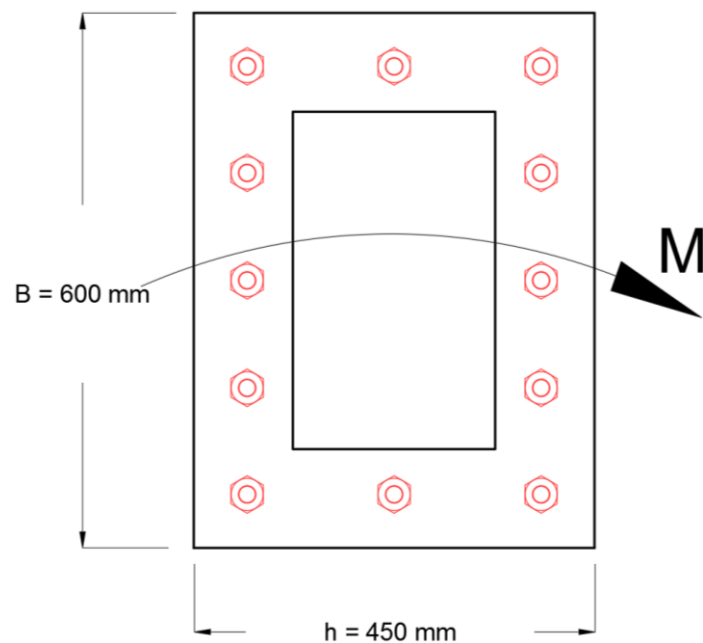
Distribución de barras del conector en el pilar 53 y 56
